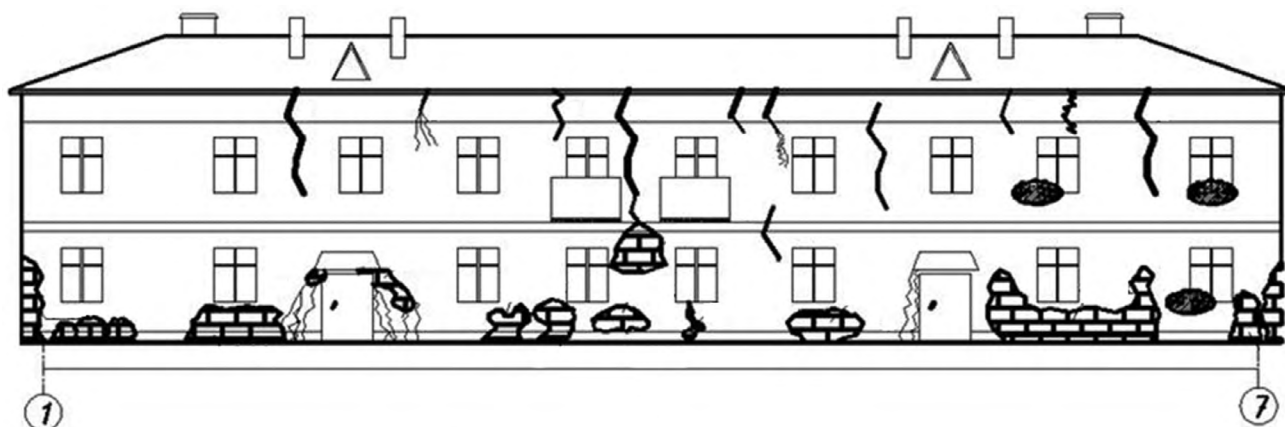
Карта повреждений и дефектов стен фасада в осях 1–7
